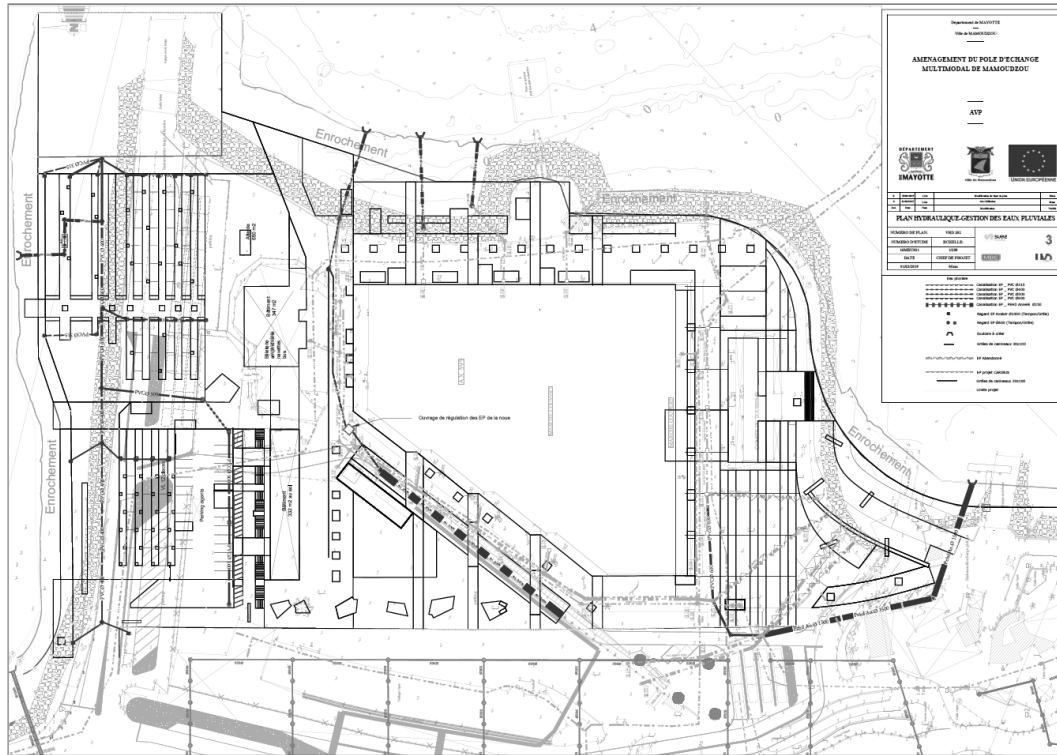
Plan de gestion des eaux pluviales projetées (AVP, mars 2019)
